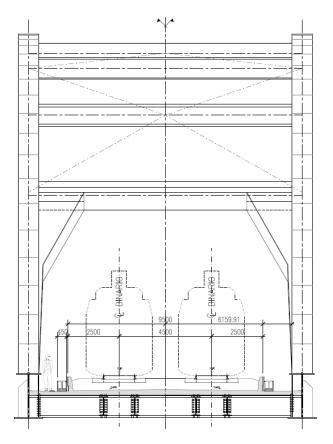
Sezione tipo - trasversale impalcato metallico da 78m.
